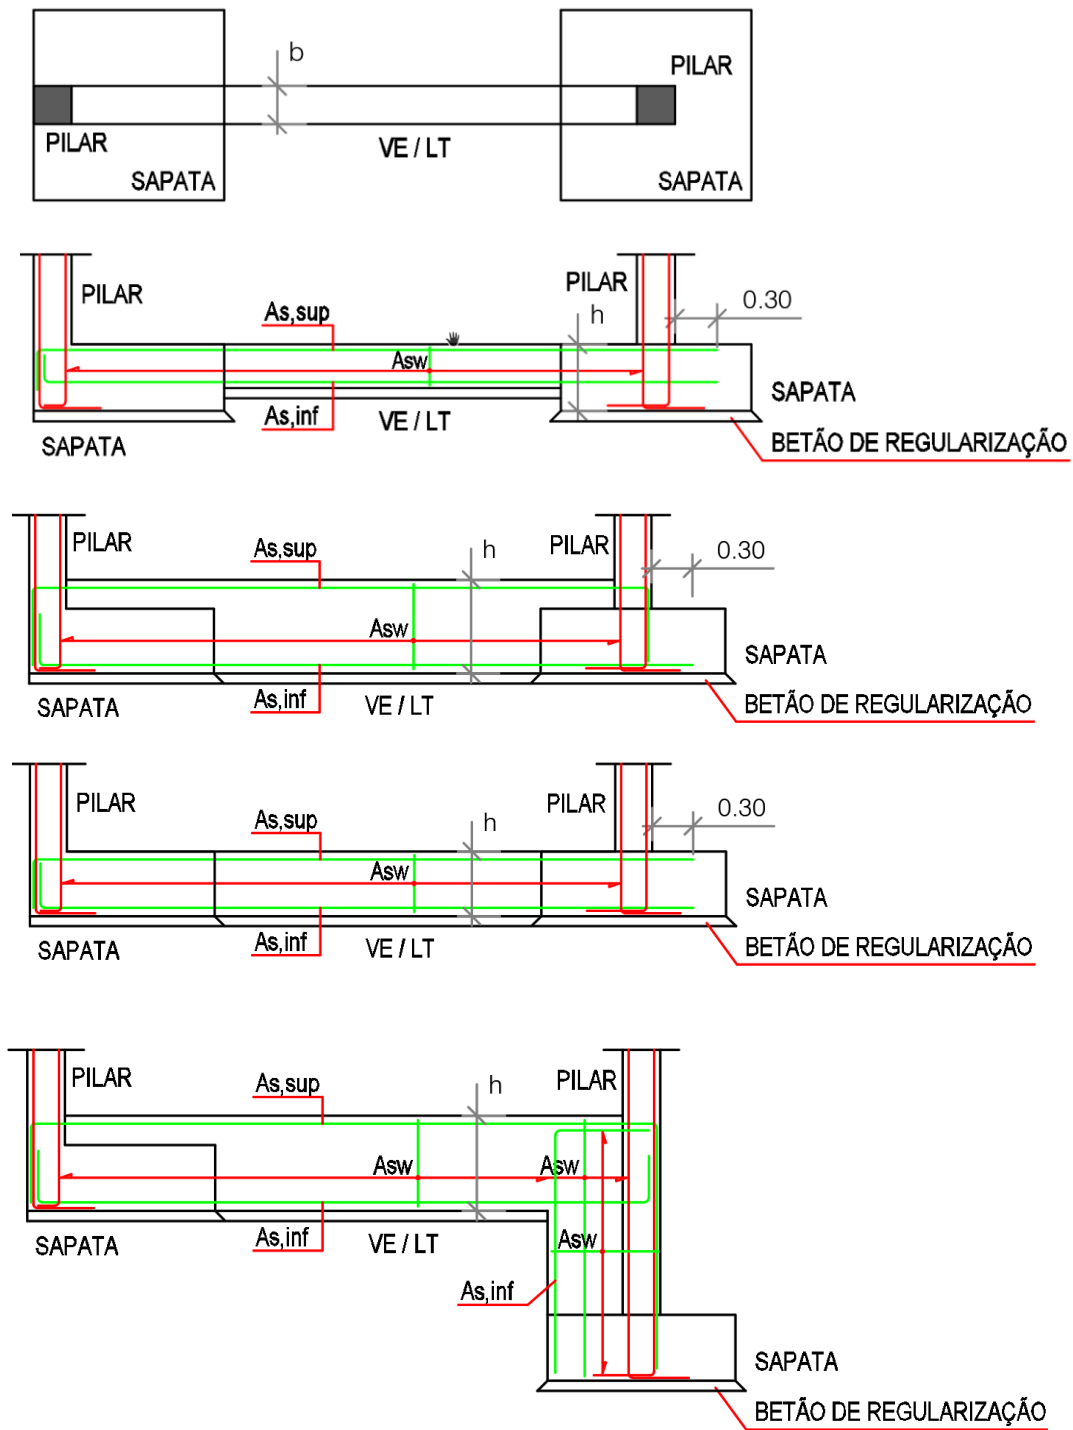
Pormenor tipo vigas de equilíbrio (Projeto de estruturas).
